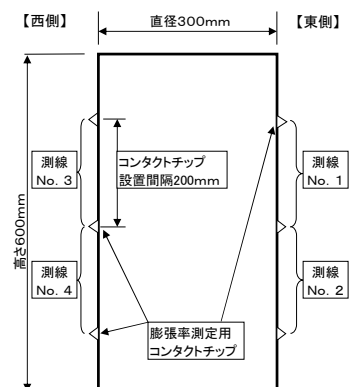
屋外暴露コンクリート供試体のコンタクトチップの設置概要
